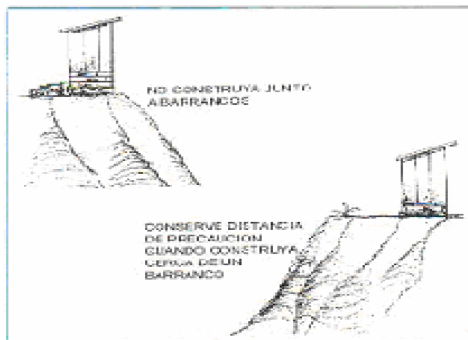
Construcción de LASF en lugares cercanos a barrancas
